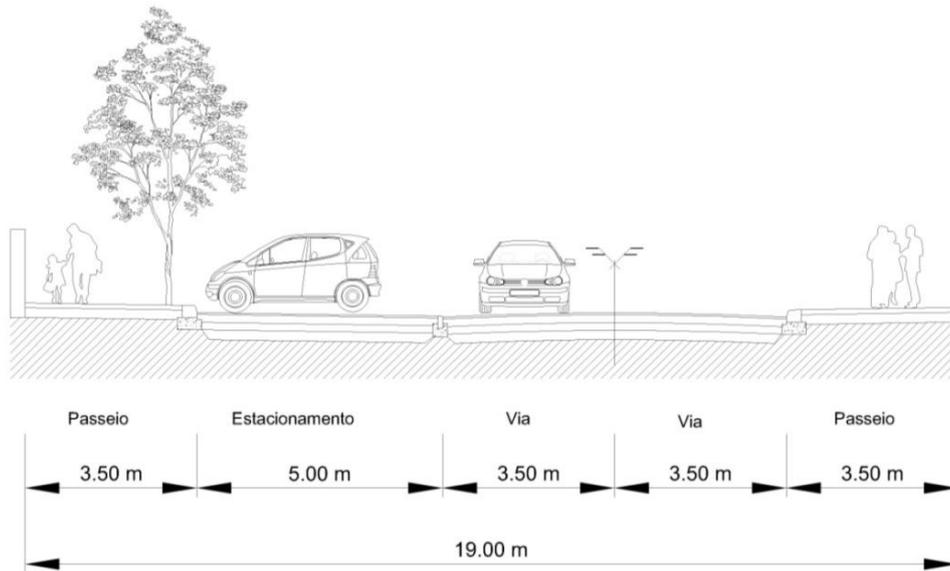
Perfil Transversal Tipo da via da escola de Ferragudo
